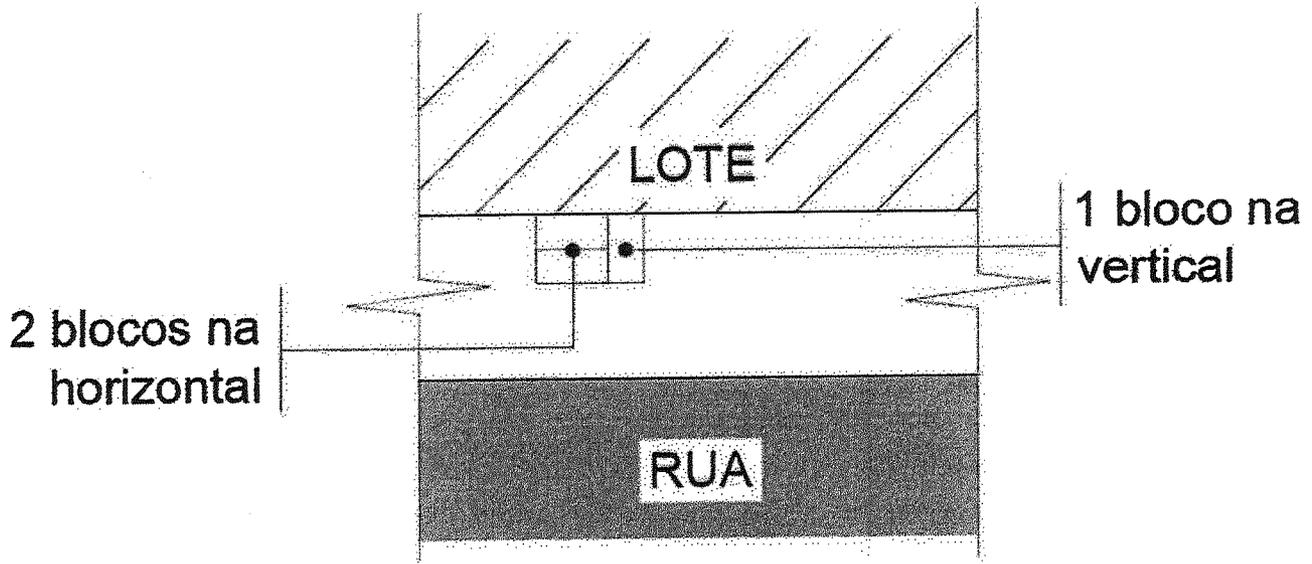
Croqui ilustrativo da disposição dos blocos.
